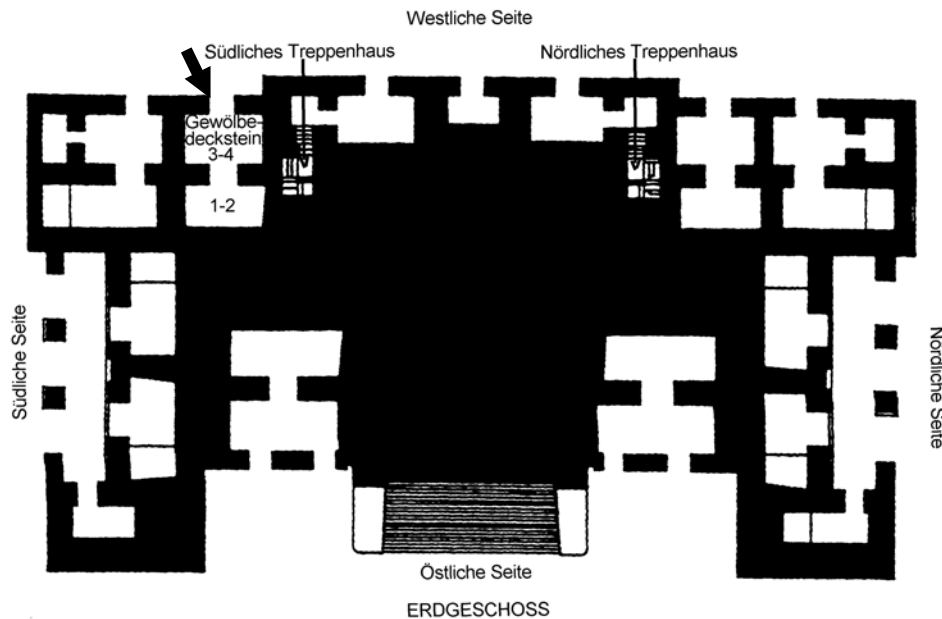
»Palastgebäude« mit übermalten Gewölbedecksteinen (nach Andrews 1987:284, Fig. 11, mit Ergänzungen).
